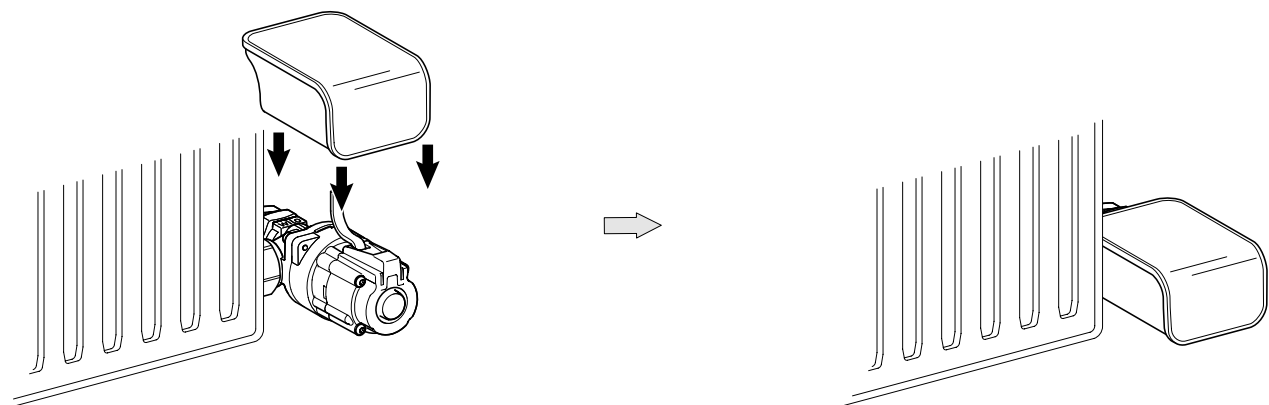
Geniax Design Abdeckung MC für Pumpe/Adapter Set Eck/Winkel (Rücklaufadapter)
